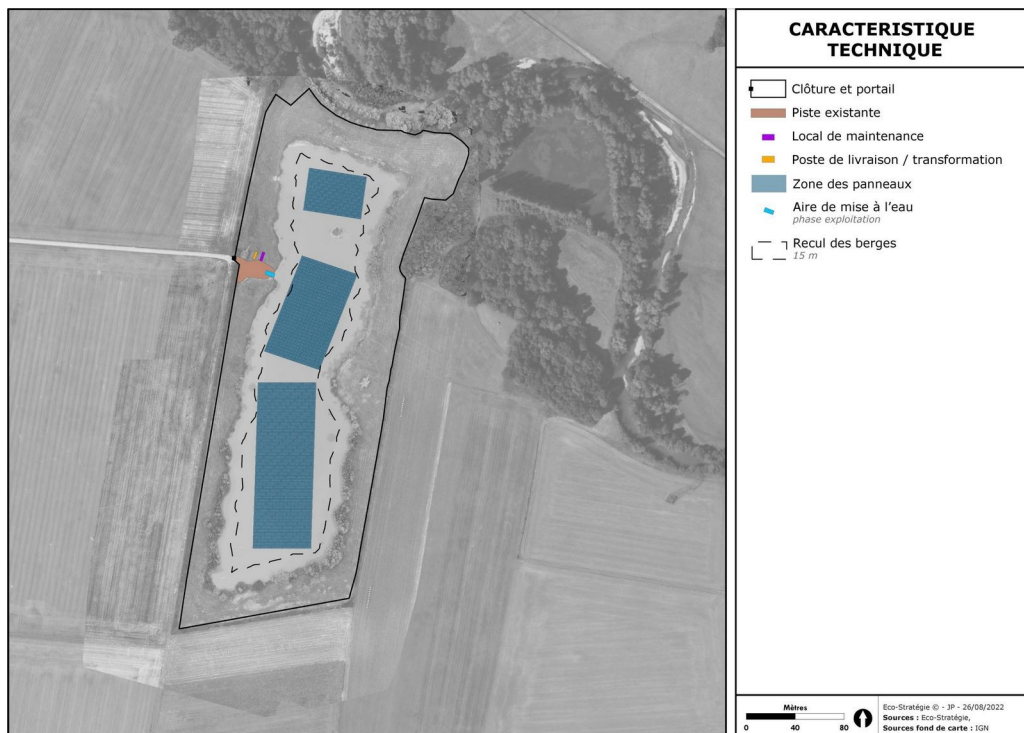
Plan masse du projet (Source : étude d'impact - §.4.3.2)
